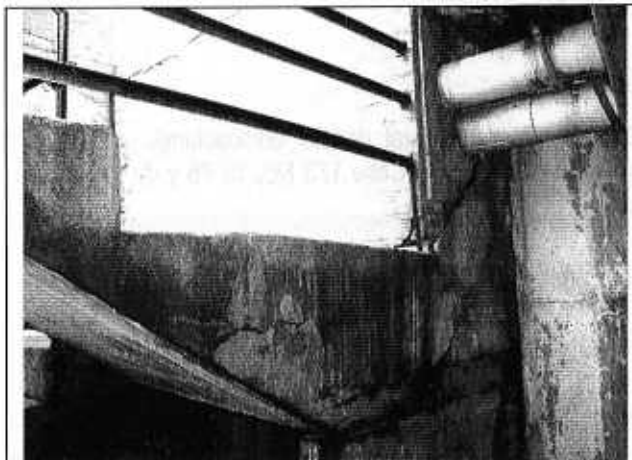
Grietas en elementos estructurales y no estructurales de una de las escaleras de acceso al sótano de parqueadero.
